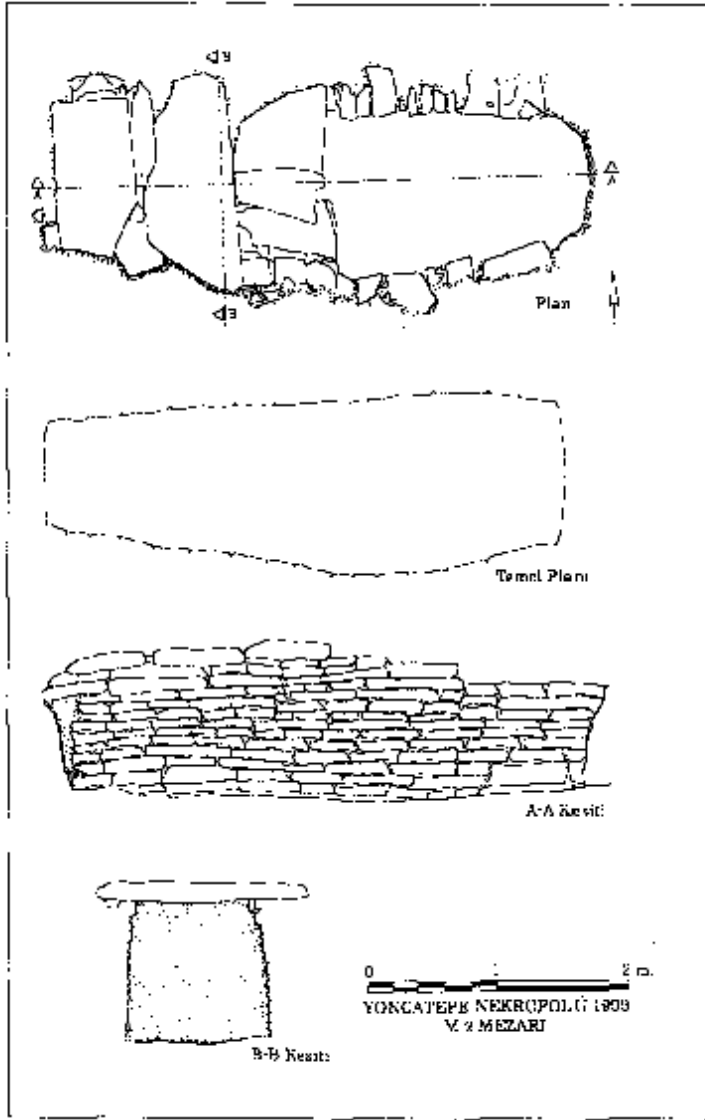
Mezar 1 plan ve kesiti [36].
